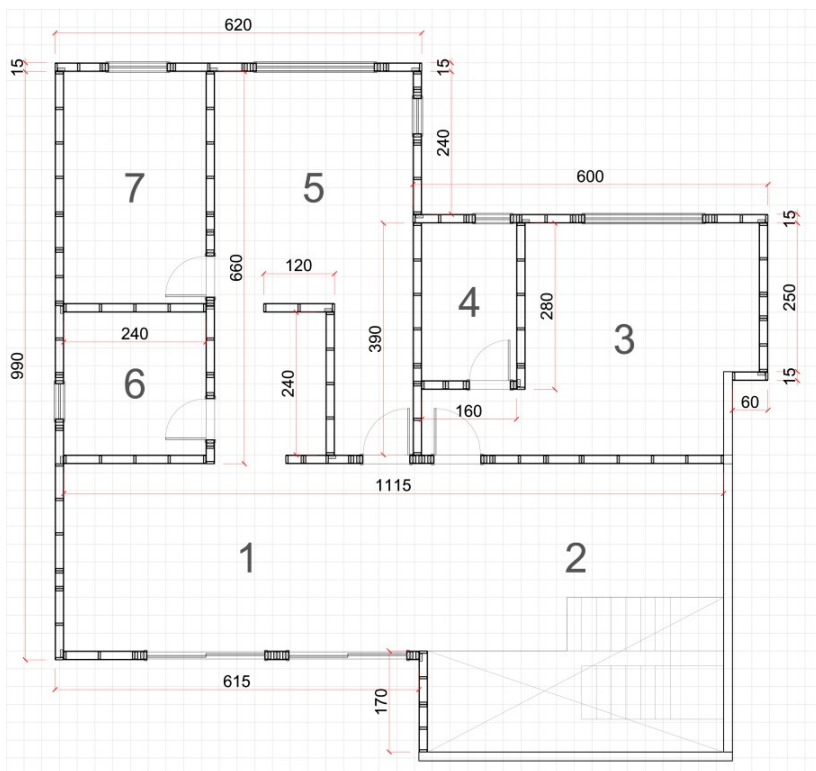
Identificação dos painéis tipo utilizados no pavimento térreo. Sem escala.
